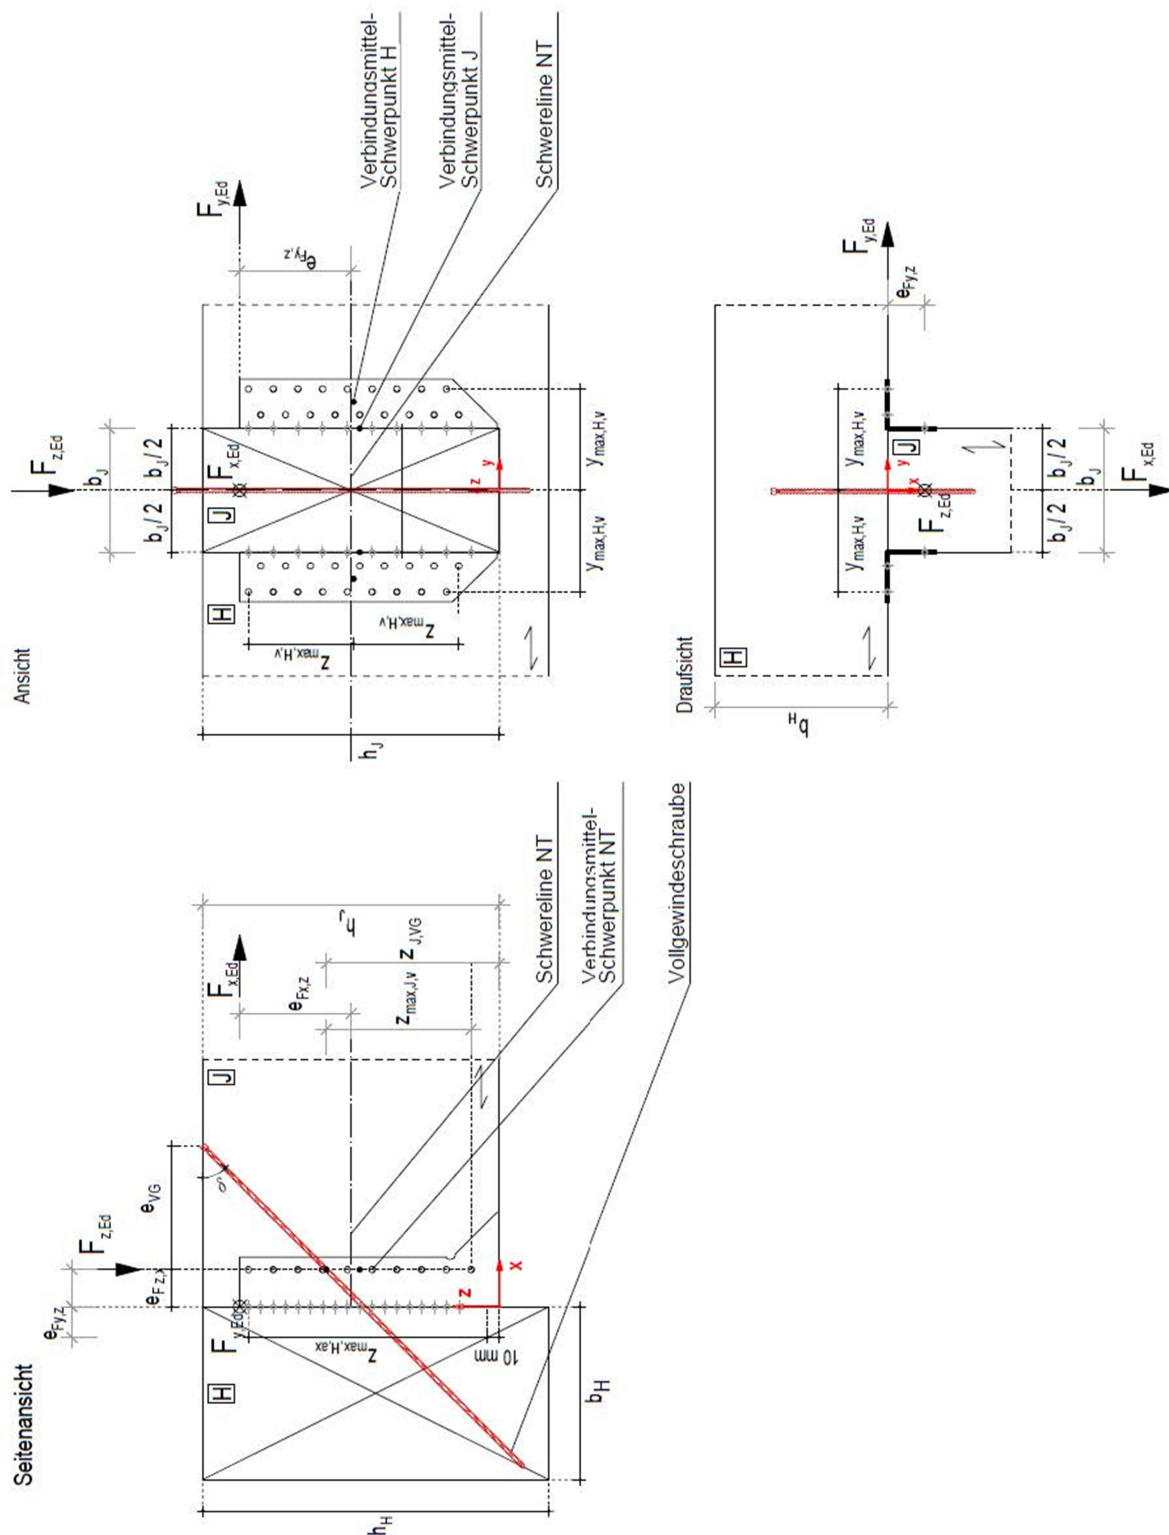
Schräge Schrauben für Kraft  $F_{x,Ed}$
